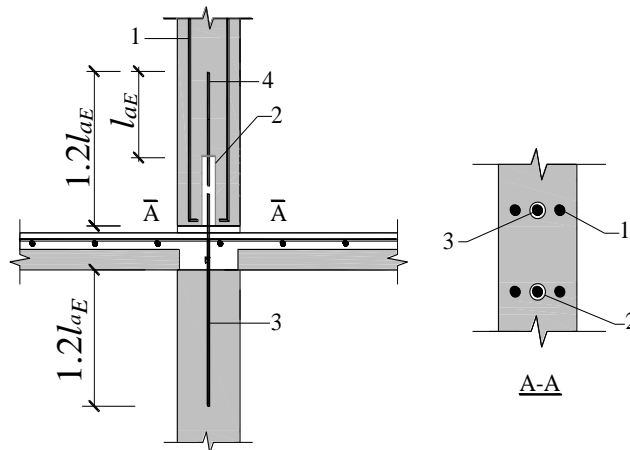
竖向分布钢筋单排套筒灌浆连接构造示意
